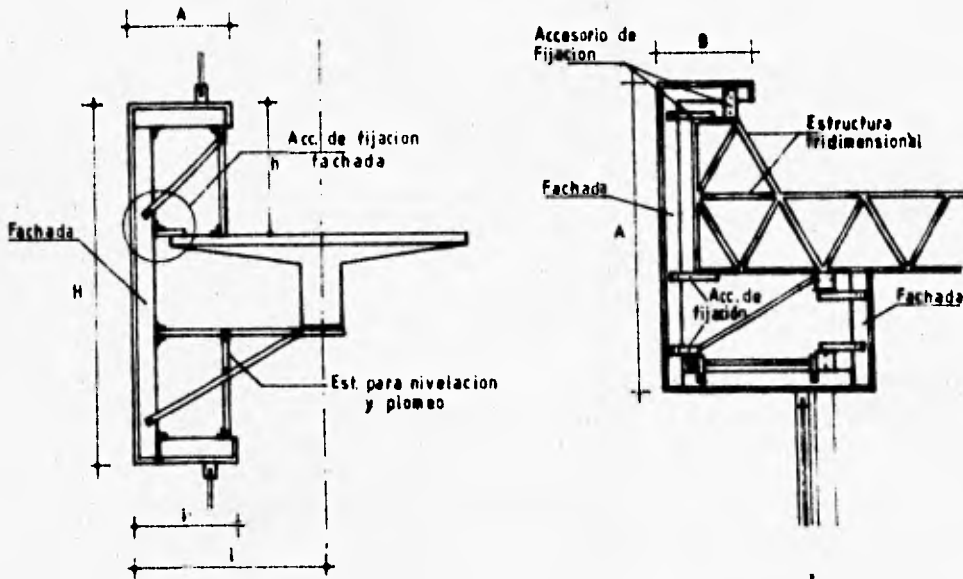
FACHADAS PREFABRICADAS PREFASA.
